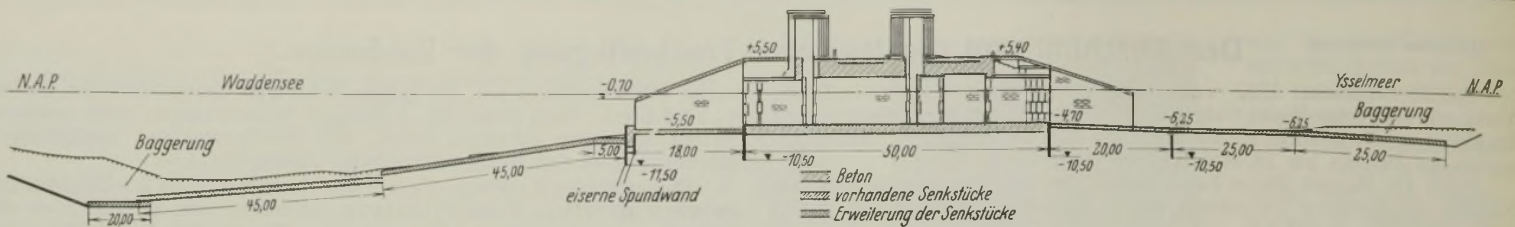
Schnitt durch eine Schleuse und das Sturzbett.
